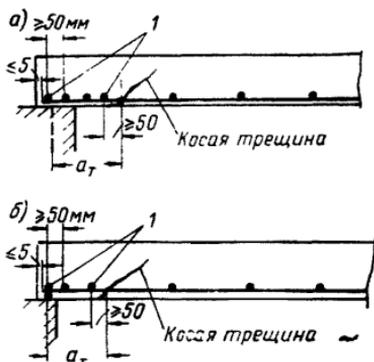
Примеры анкеровки растянутых стержней арматуры на опорах плит из ячеистого бетона
